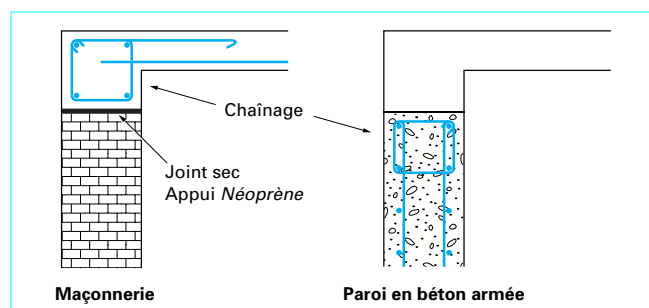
Appui sur mur en béton, béton armé ou maçonnerie
